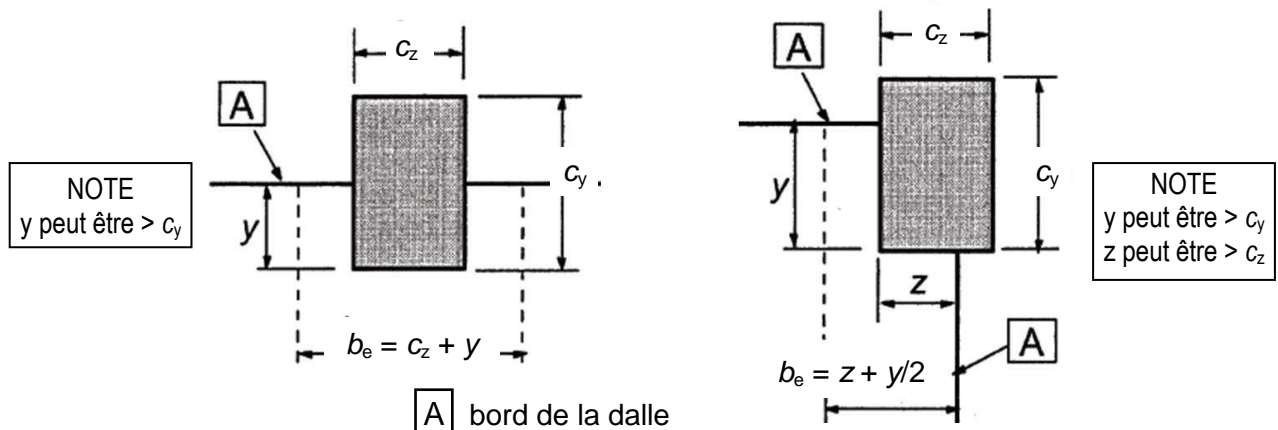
(EC 2-1-1, Fig. 9.9) : Largeur participante b_e en bords d'un plancher-dalle.
